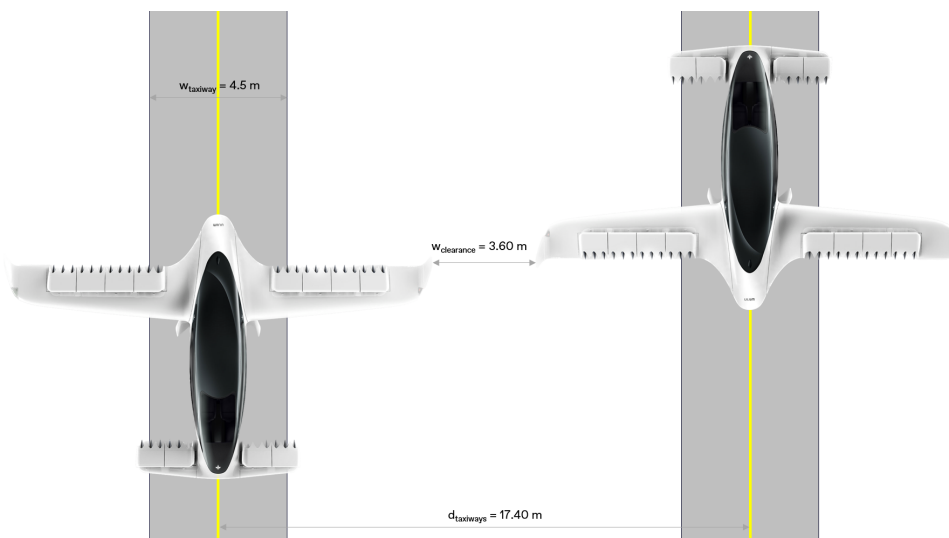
Distribución correspondiente al dimensionado de las calles de rodaje para el vertiportuerto planteado.
